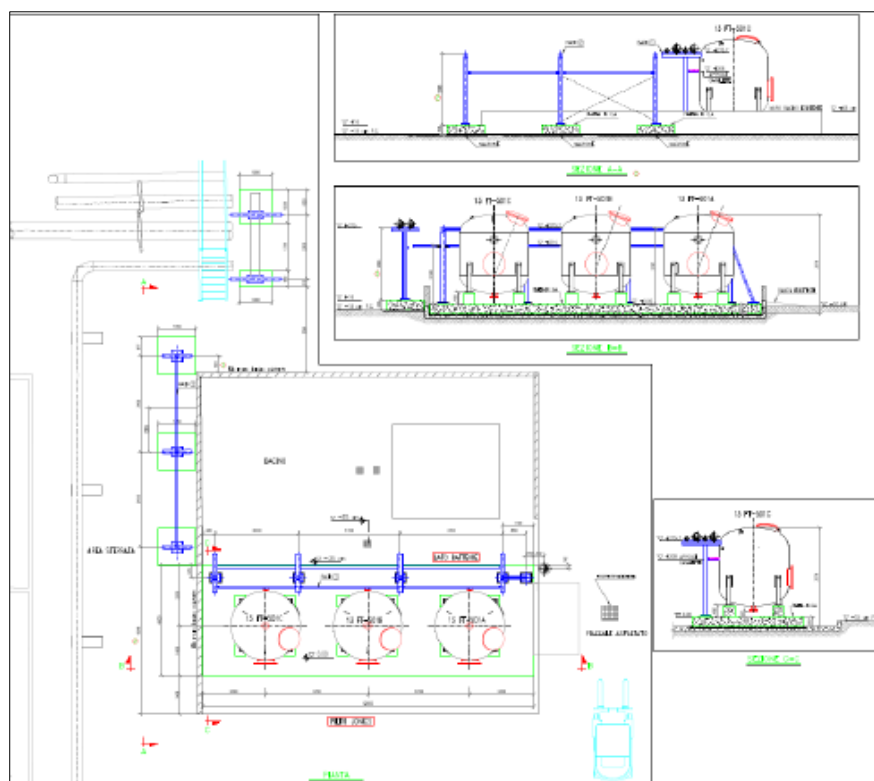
Stralcio del layout del nuovo sistema di filtrazione
